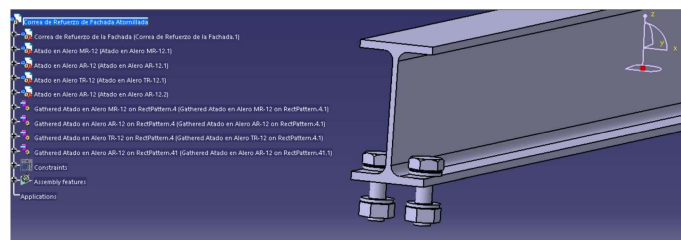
Representación 3D de la correa de refuerzo de la fachada con la tornillería
